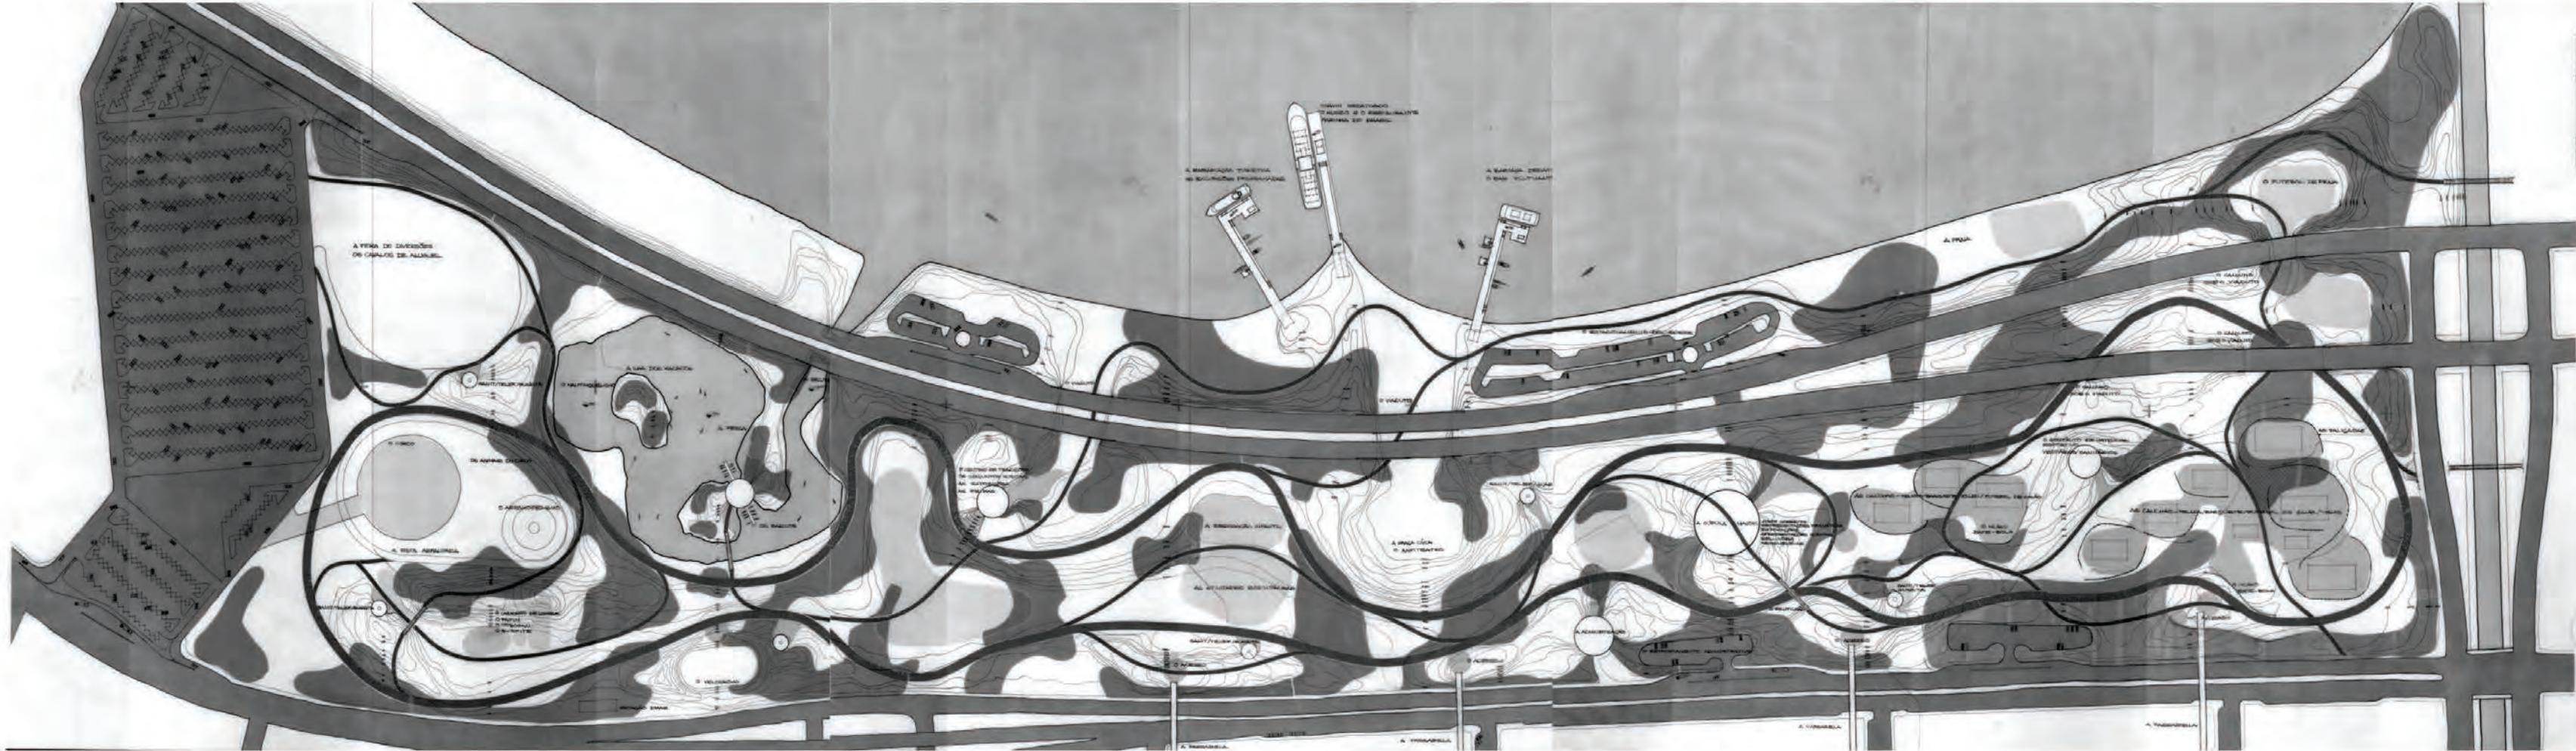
Planta geral da proposta de Araújo e Comas, proposta original do concurso.
